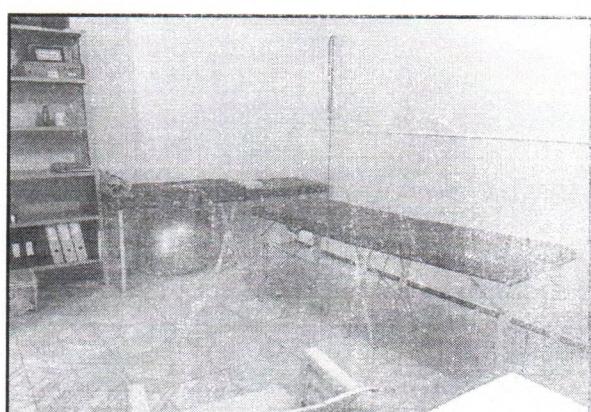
Vista da Sala para NASF, com destaque ao piso cerâmico
